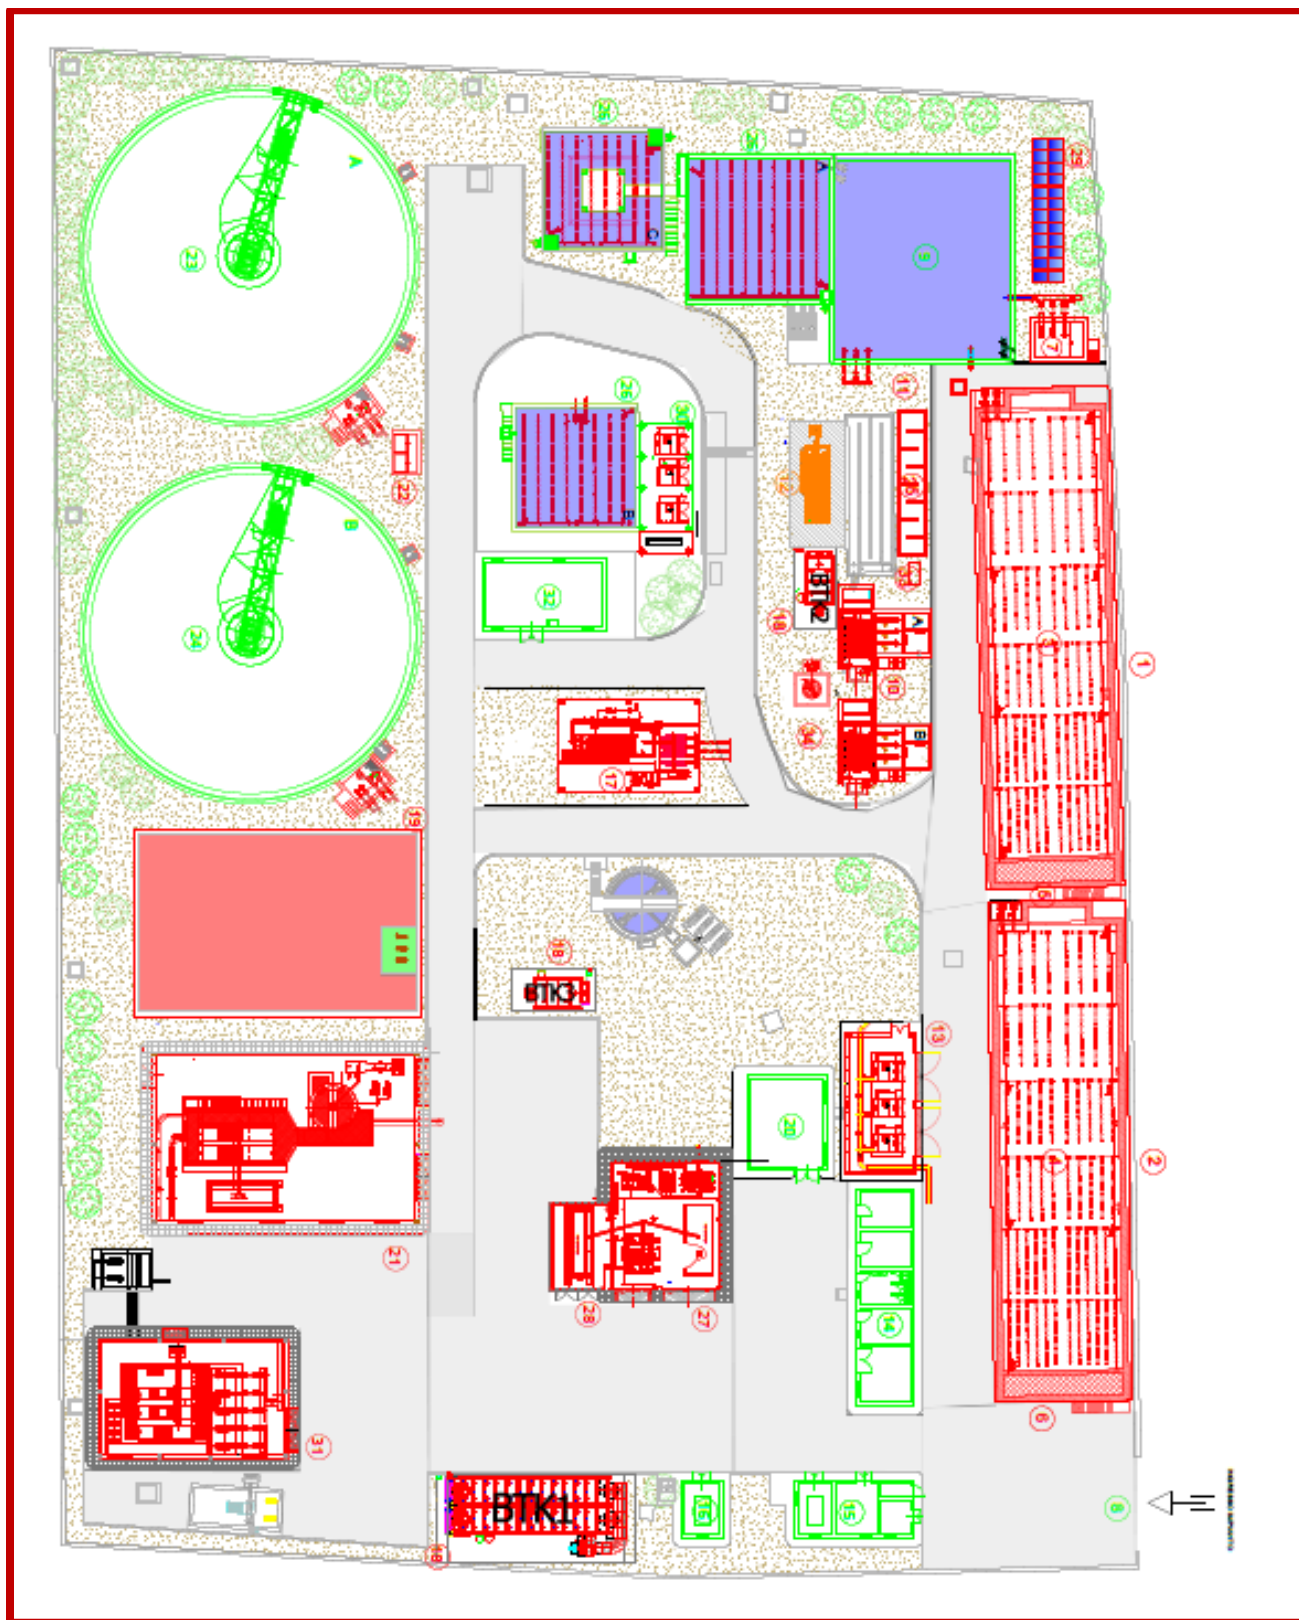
Planimetria dell'impianto nella configurazione di progetto
